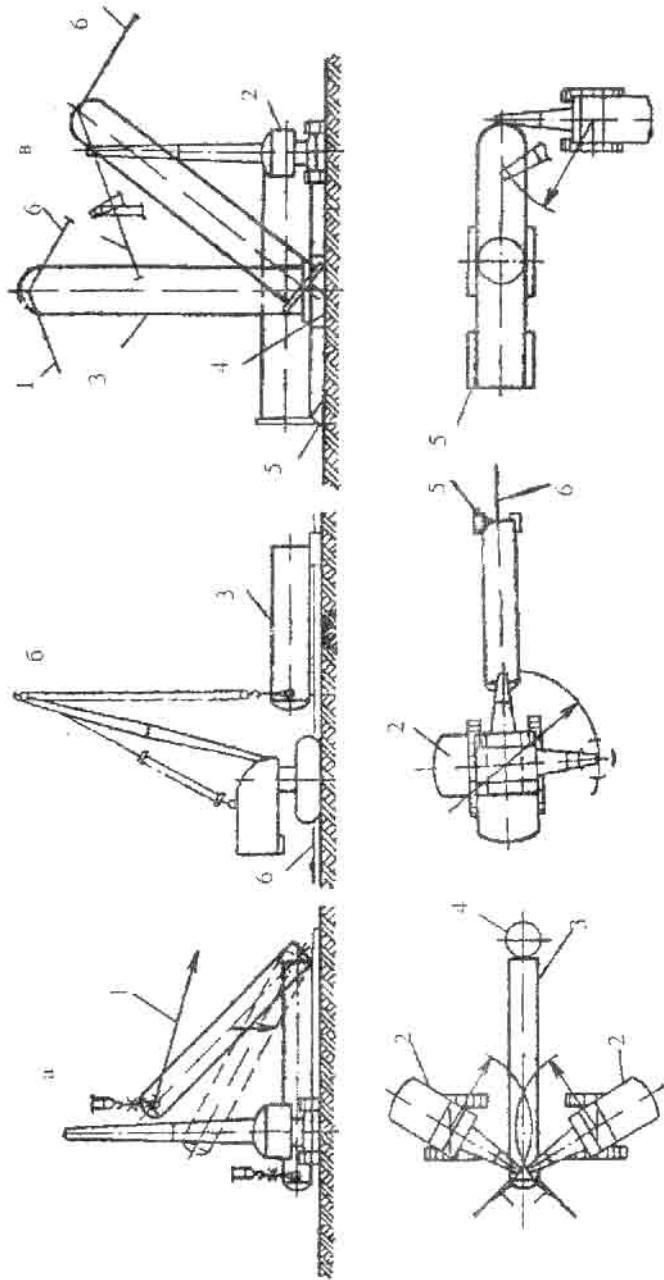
Схемы методов монтажа вертикальных ангаров стреловыми кранами:
